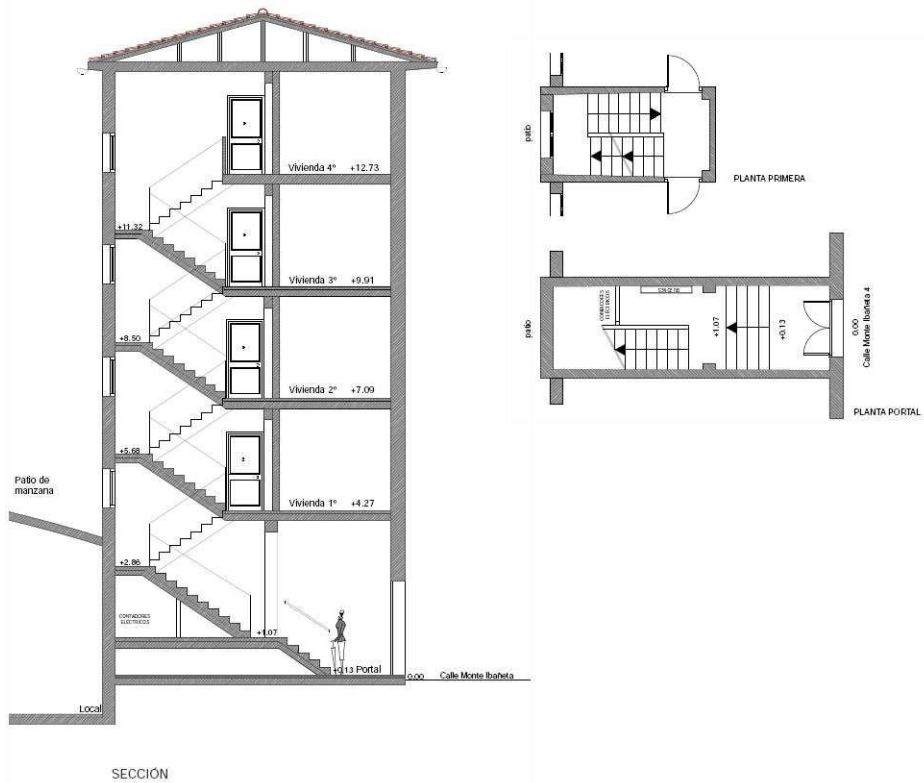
Planos de sección, planta baja y planta tipo del estado actual del proyecto de rehabilitación con instalación de ascensor en Calle Monte Ibañeta 4 de Pamplona. Fuente propia.
